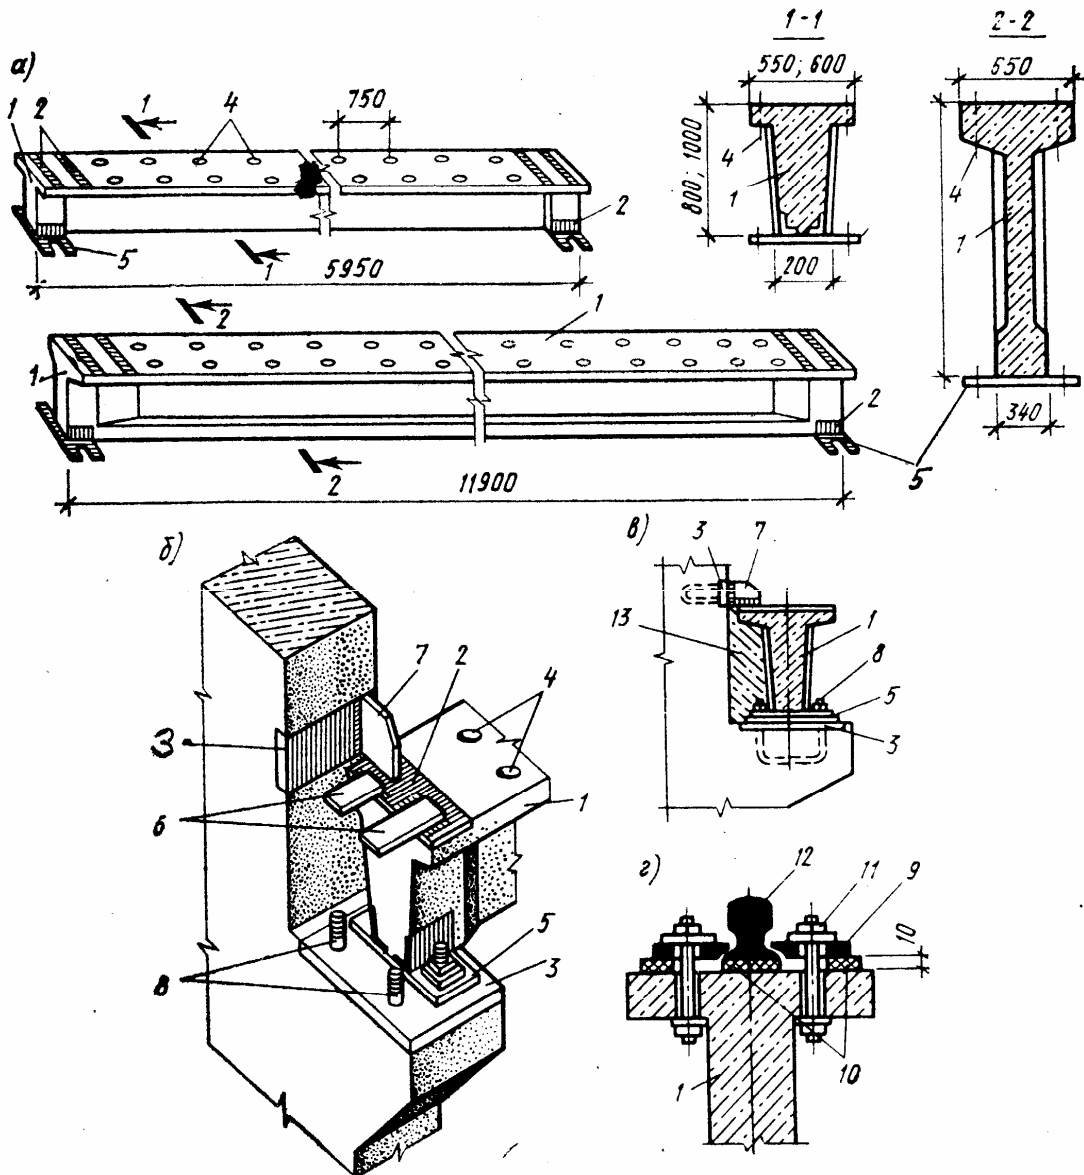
Железобетонные подкрановые балки (а), узлы их опирания на колонны (б, в) и крепление кранового рельса (г)
